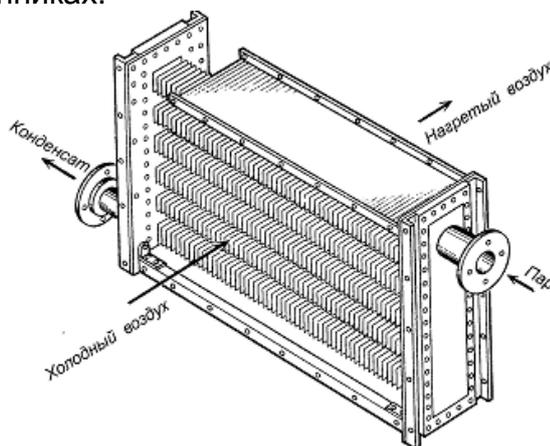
Пластинчатый калорифер для подогрева воздуха
